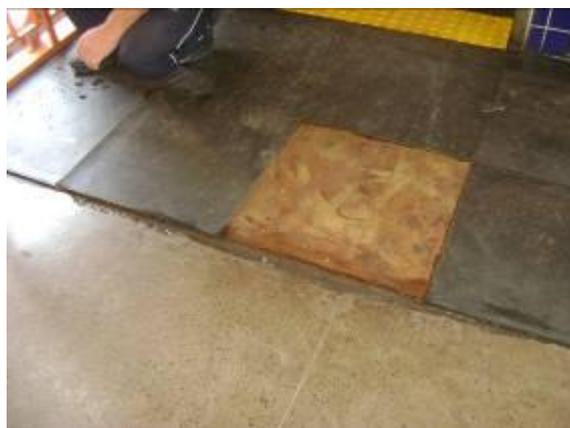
Piso podotátil, colado sobre chapas metálicas corroídas pela ferrugem.
